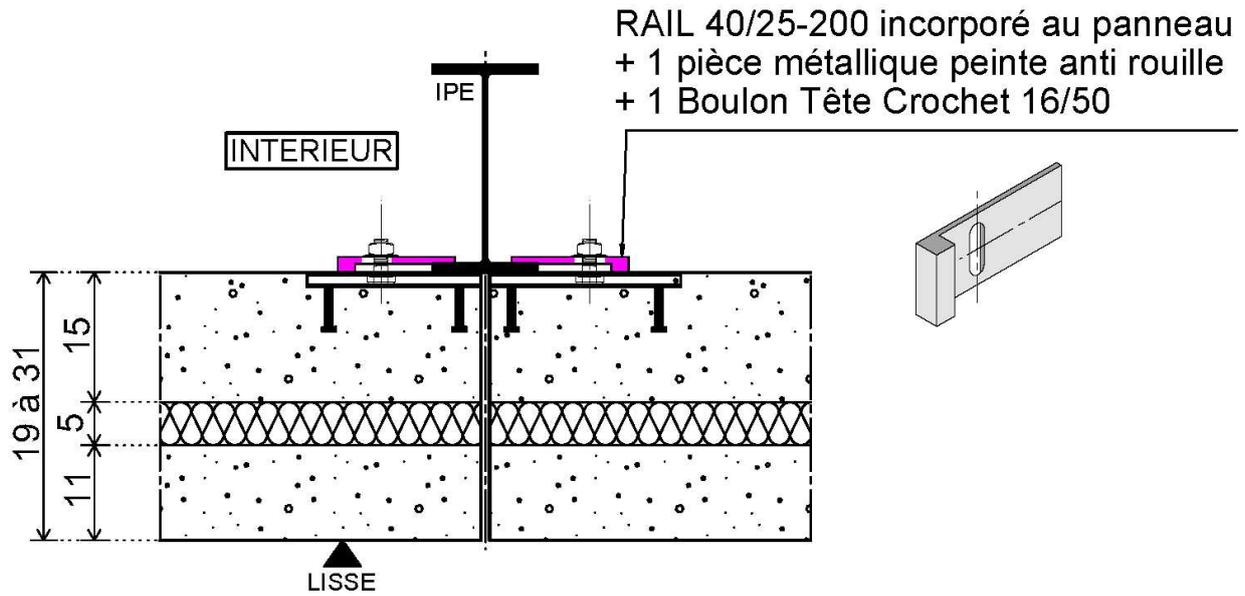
Panneaux sandwichs d'habillage d'ossature (type longrine de bâtiment industriel) – coupe horizontale – fixation par rail
